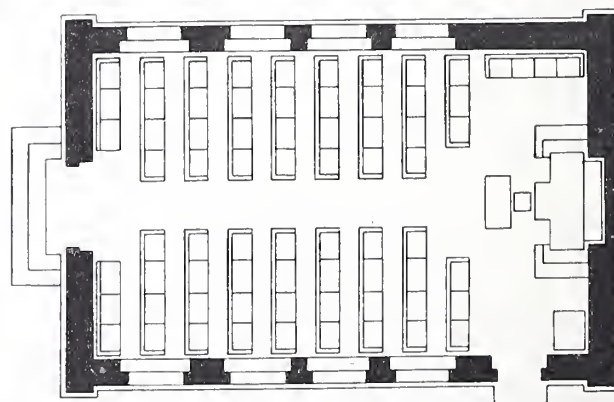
Chapelle de Duilliers. — Plan. — Echelle 1 : 125.
